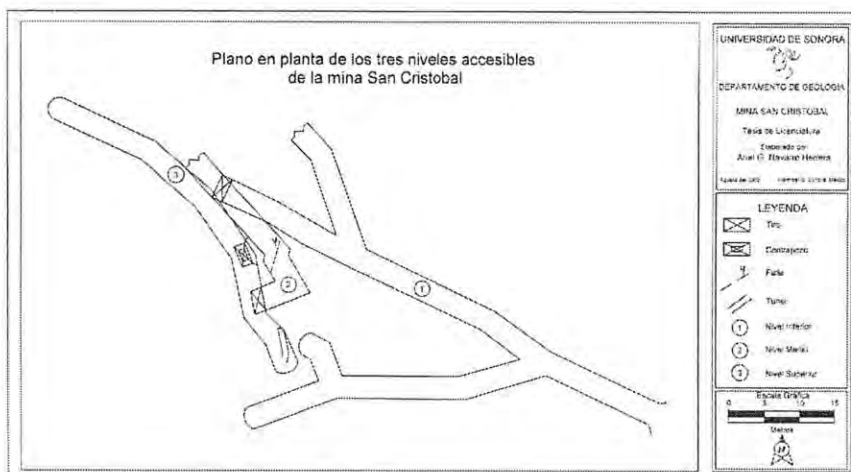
Plano en planta de los 3 niveles accesibles de la mina San Cristóbal.
